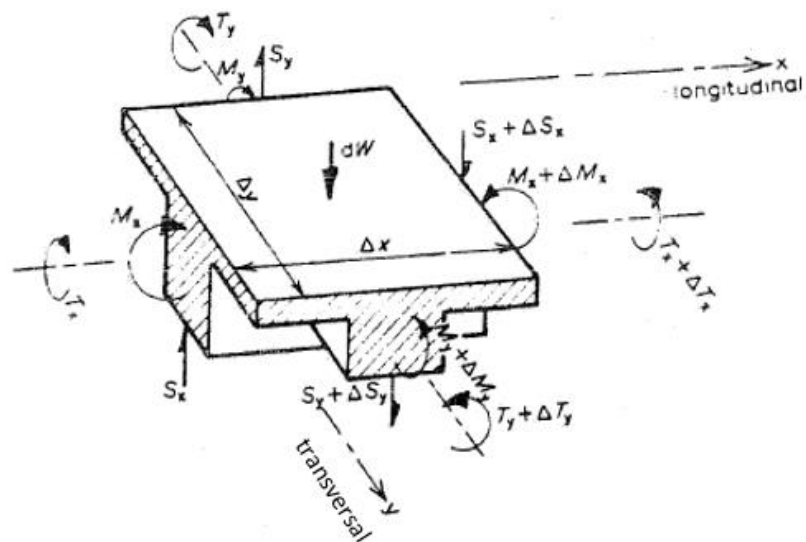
Elemento de tabuleiro em grelha ou tabuleiro em vigas e laje com transversina. Fonte: Adaptado de Hambly (1991)
